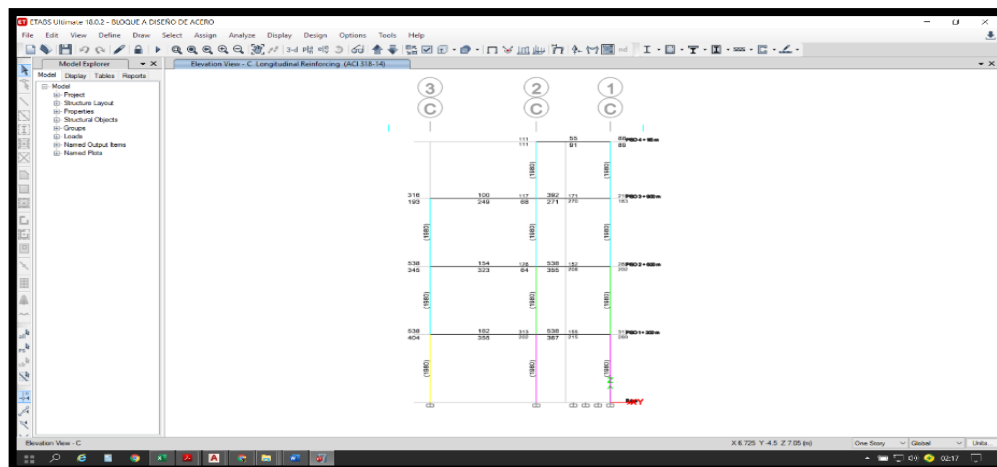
Bloque A - Acero longitudinal en el eje elevación eje C-C
